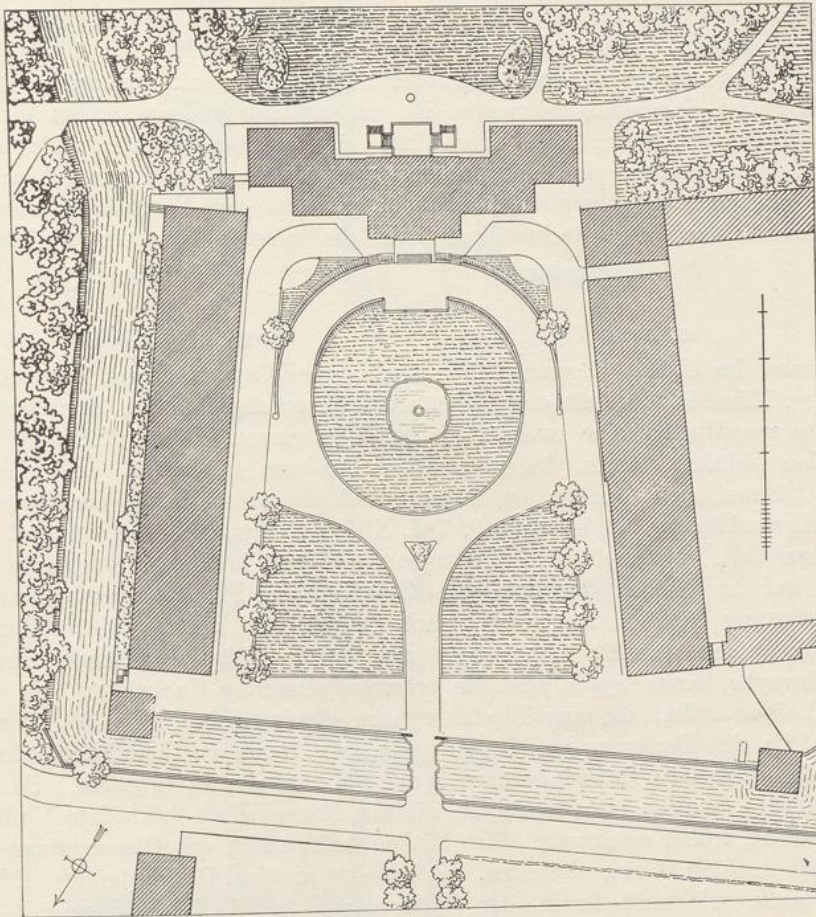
Schloß Söder; Lageplan (Maßstab 1:1500).
